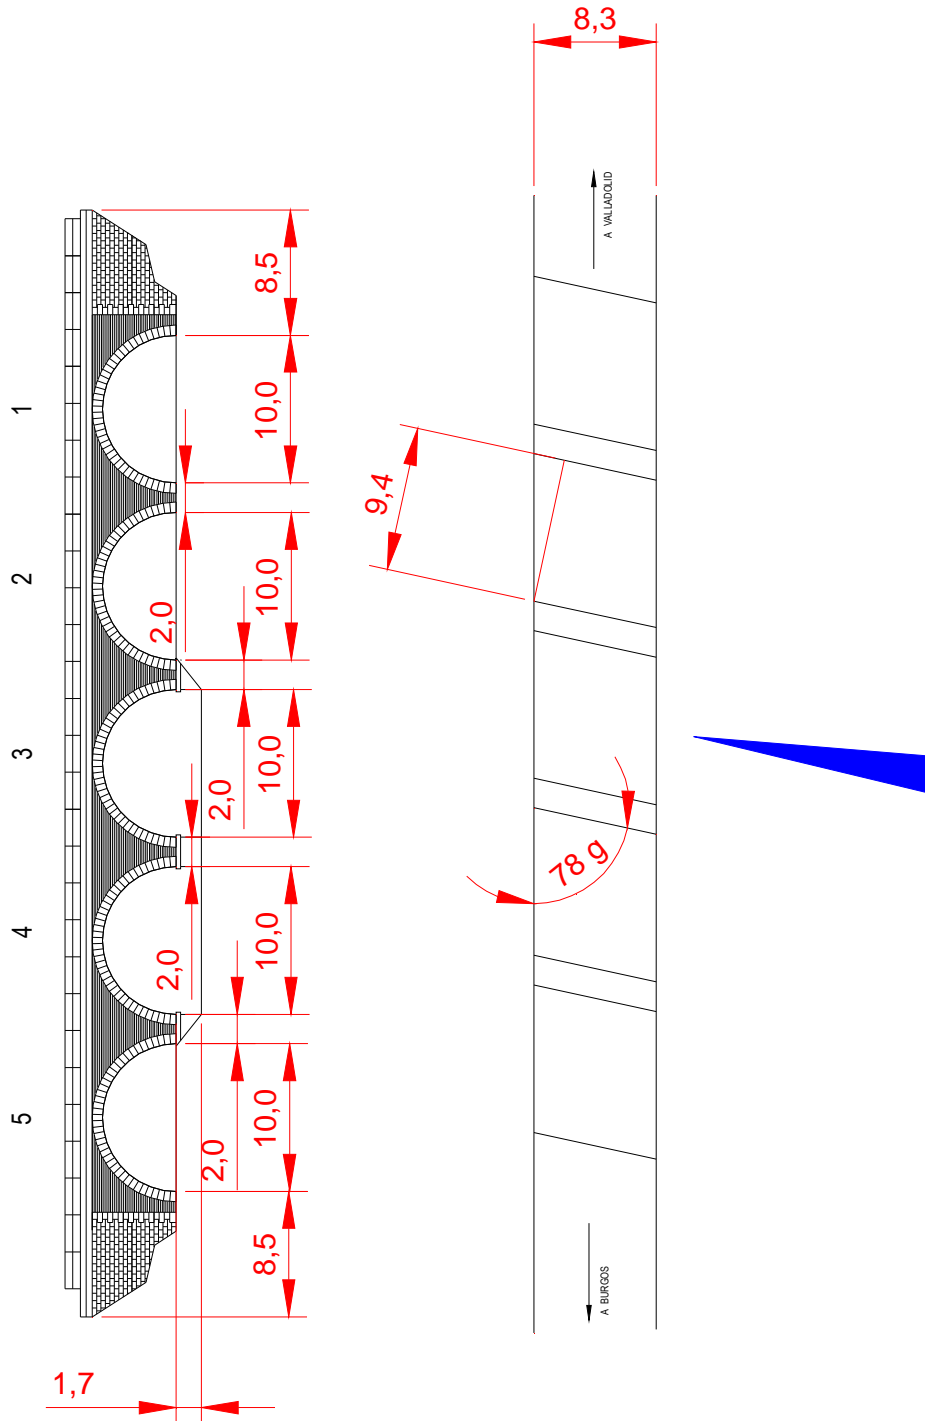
Planta y alzado de aguas arriba del puente del ferrocarril en Dueñas
